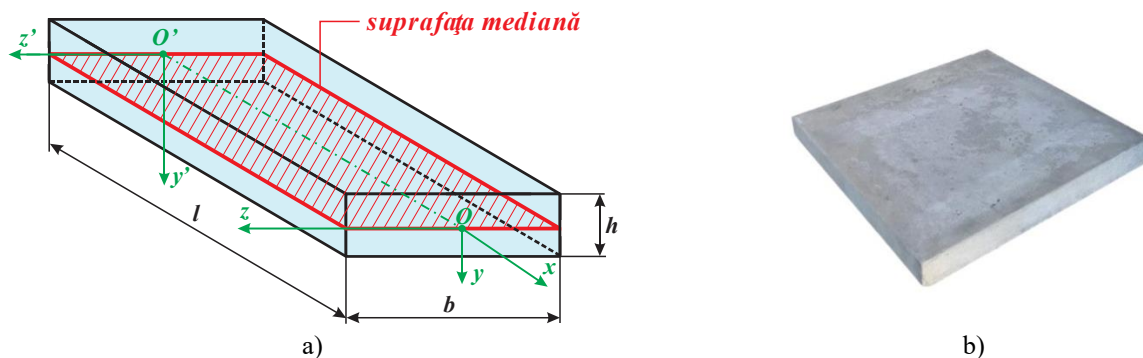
Placă dreaptă: a) Schematizare; b) Exemplu real: placă din beton [28]
